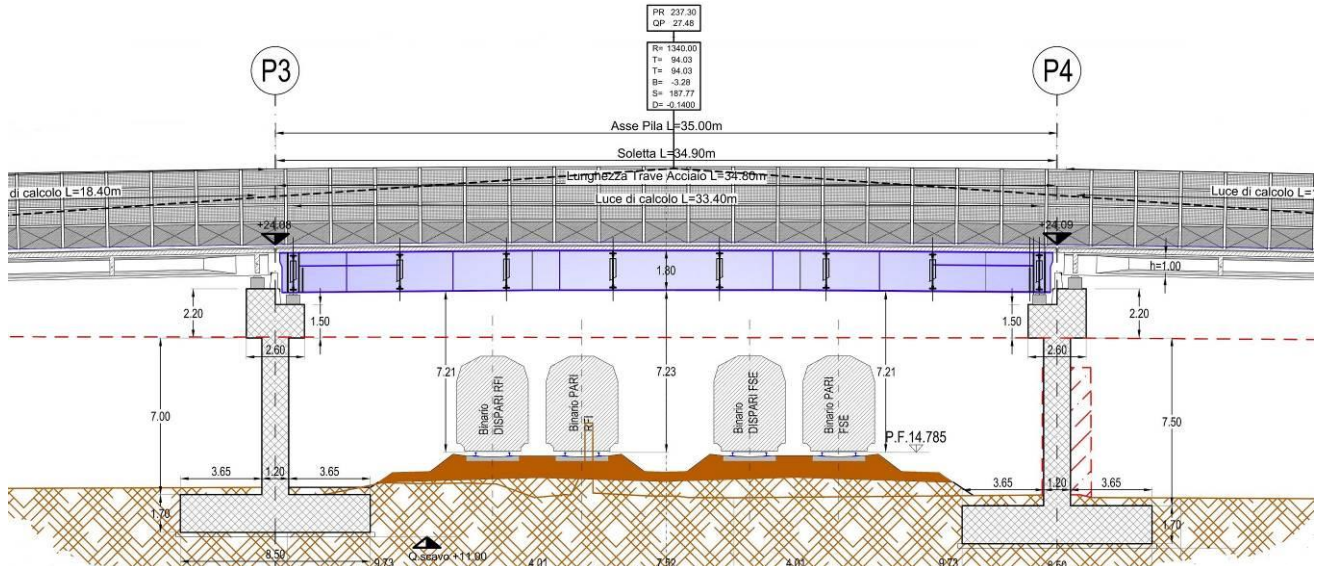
Sezione longitudinale in corrispondenza della trave in acciaio L=34.80
